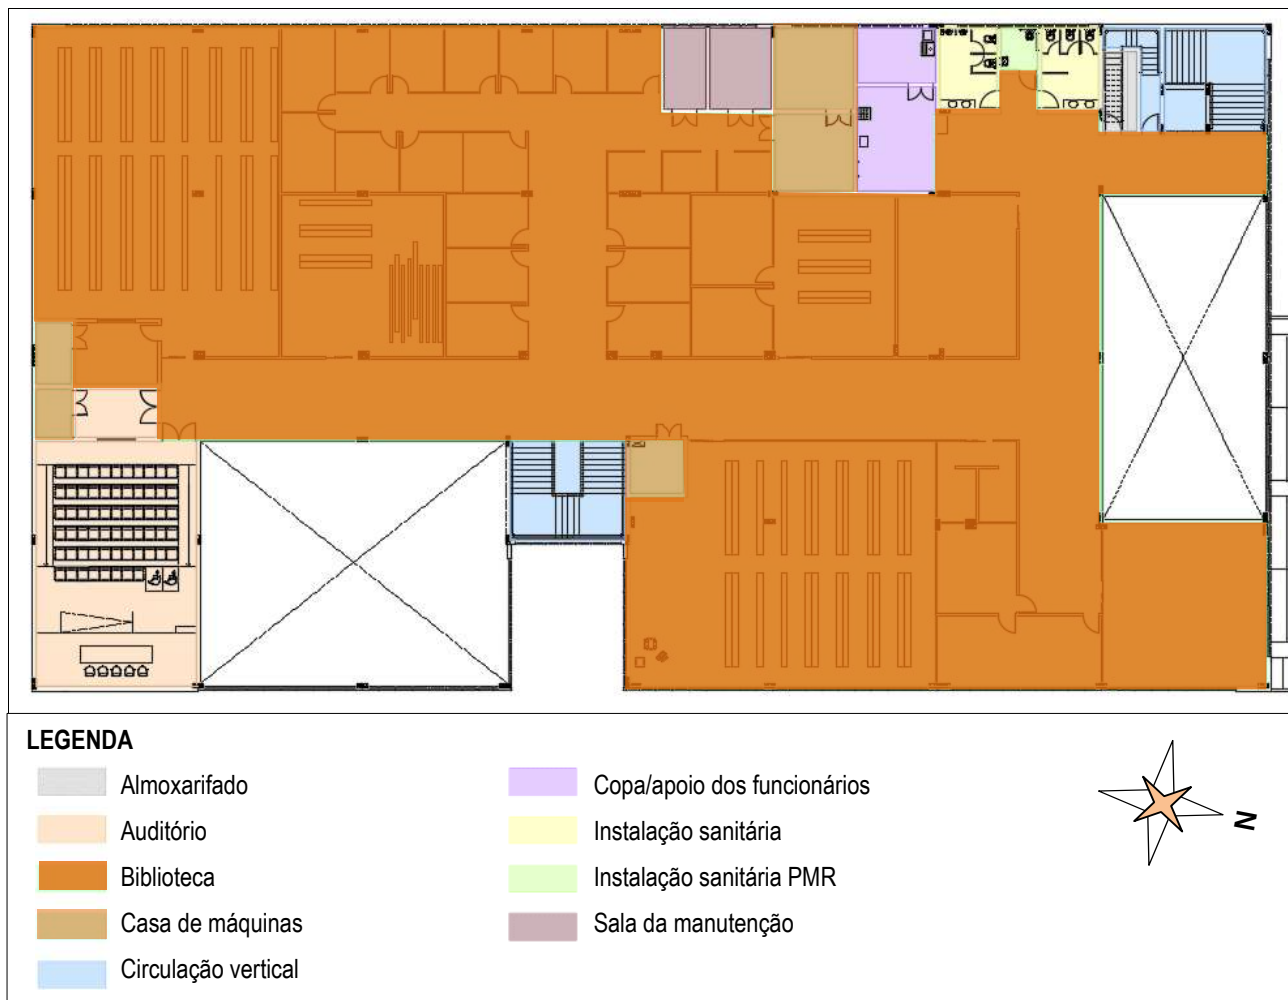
Planta setorializada do primeiro pavimento do bloco 08.
